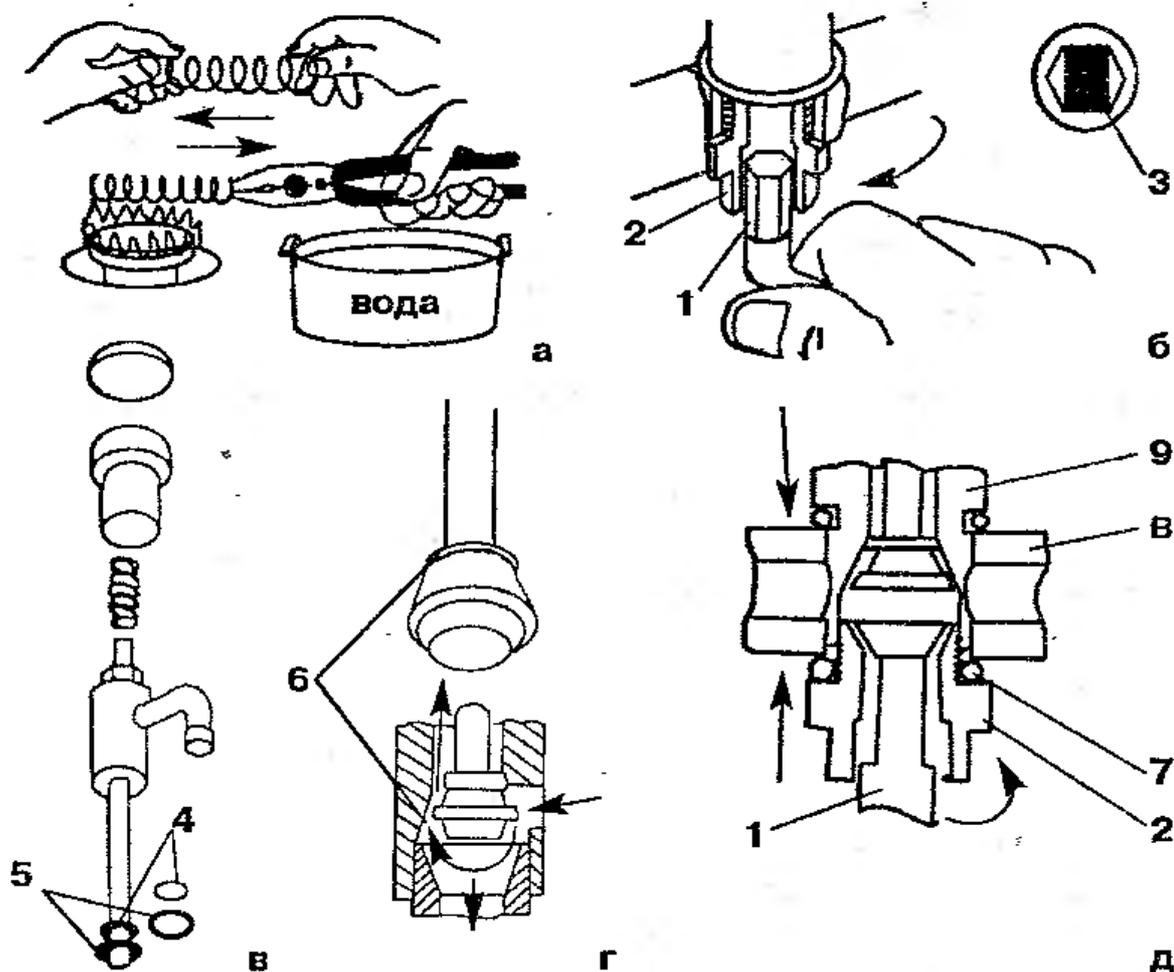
Ремонт деталей в смесителях с вертикально расположенным кнопочным переключателем: а — повышение упругости пружины; б, в — разборка переключателя и замена резиновых колец клапана; г — удаление соринки на резиновом кольце клапана; д — устранение течи через уплотнительное резиновое кольцо; 1 — самодельный торцовый ключ; 2 — переходник; 3 — прямоугольная металлическая пластина; 4 — верхнее резиновое кольцо клапана; 5 — нижнее резиновое кольцо клапана; 6 — соринка; 7 — уплотнительное резиновое кольцо; 8 — корпус; 9 — основание
